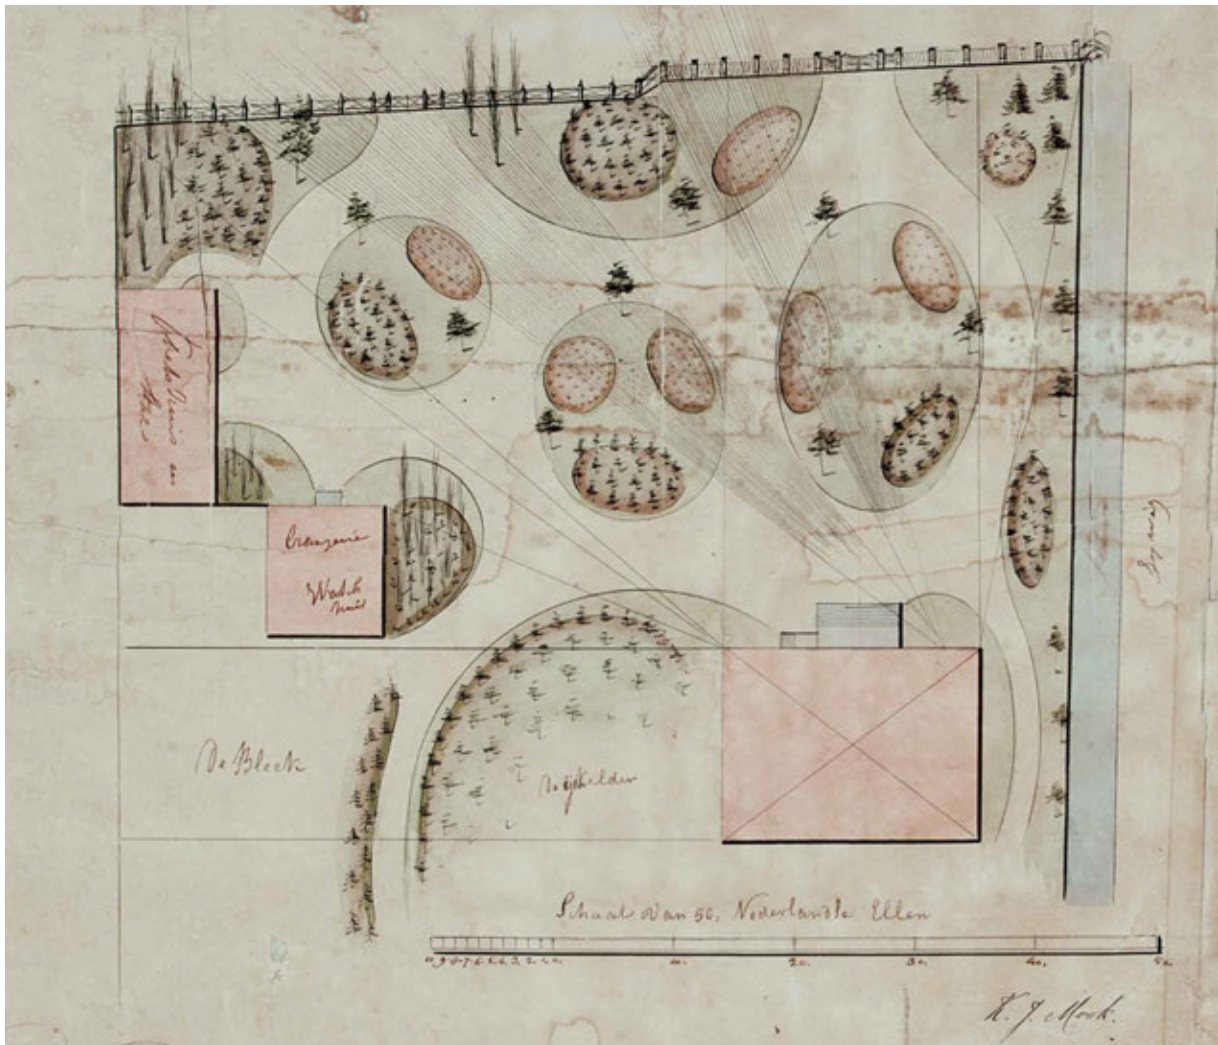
Detailtekening van het voorplein, ongedateerd (omstreeks 1837) (Bron: Tresoar 349-414)
